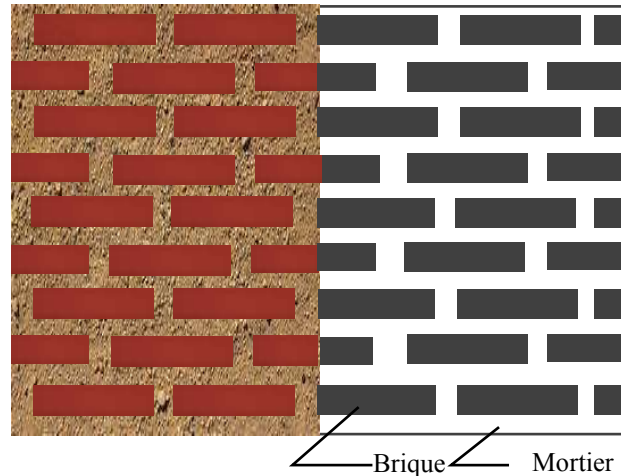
Mur de maçonnerie traditionnelle (briques / mortier) (Source : auteur)
